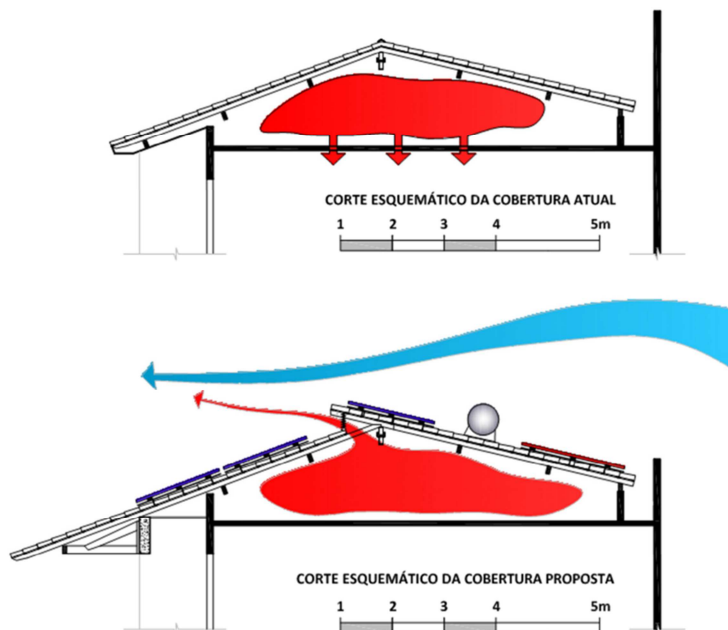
Detalhe da cobertura em telha de cerâmica – Situação atual e Situação proposta (Fonte: Larissa Amaral)
